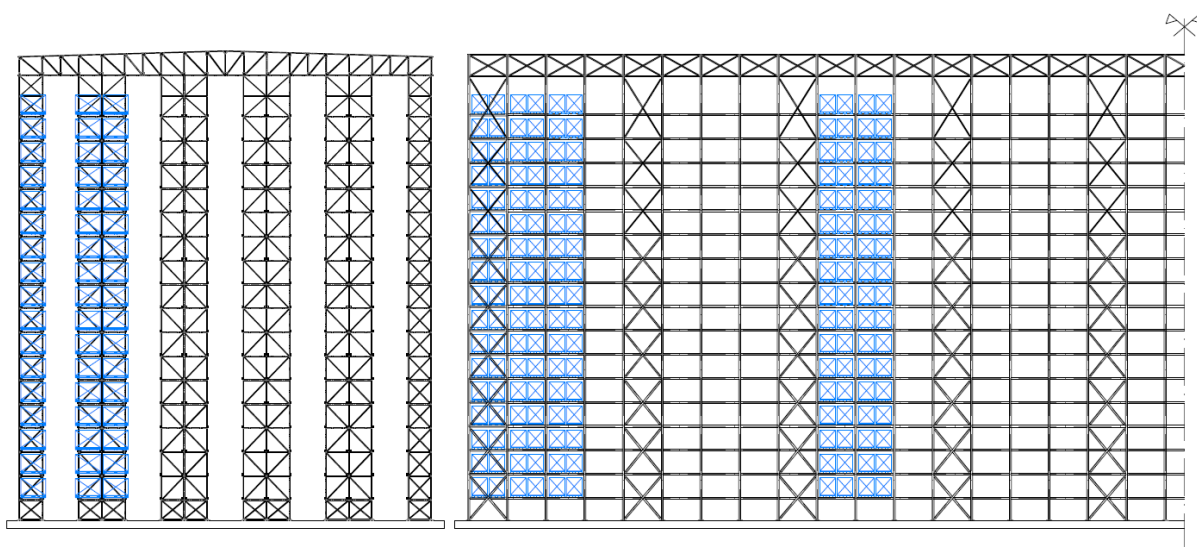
Sezione Trasversale e Longitudinale del Magazzino Autoportante Verticale, in blu la merce immagazzinata.
